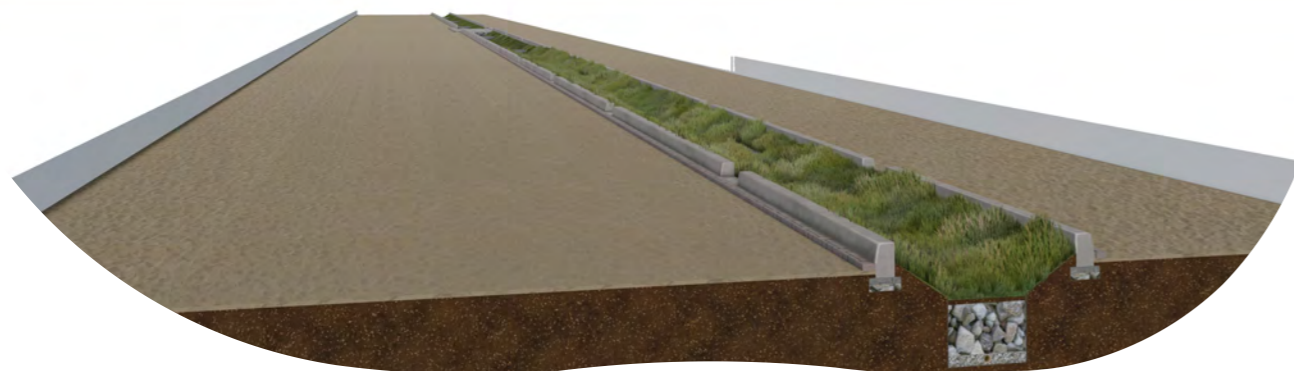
Após a Execução da segunda camada de enrocamento e dos poços de infiltração é colocada uma camada de areia e a vegetação. É também colocada a camada de areia para a pavimentação das vias.
